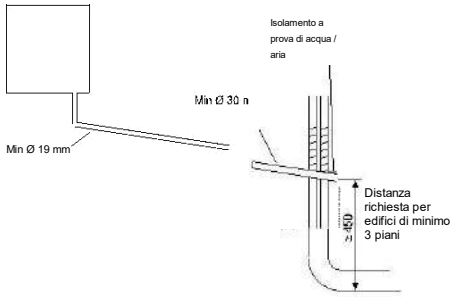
Collegamento del drenaggio della condensa al tubo di drenaggio e ventilazione
